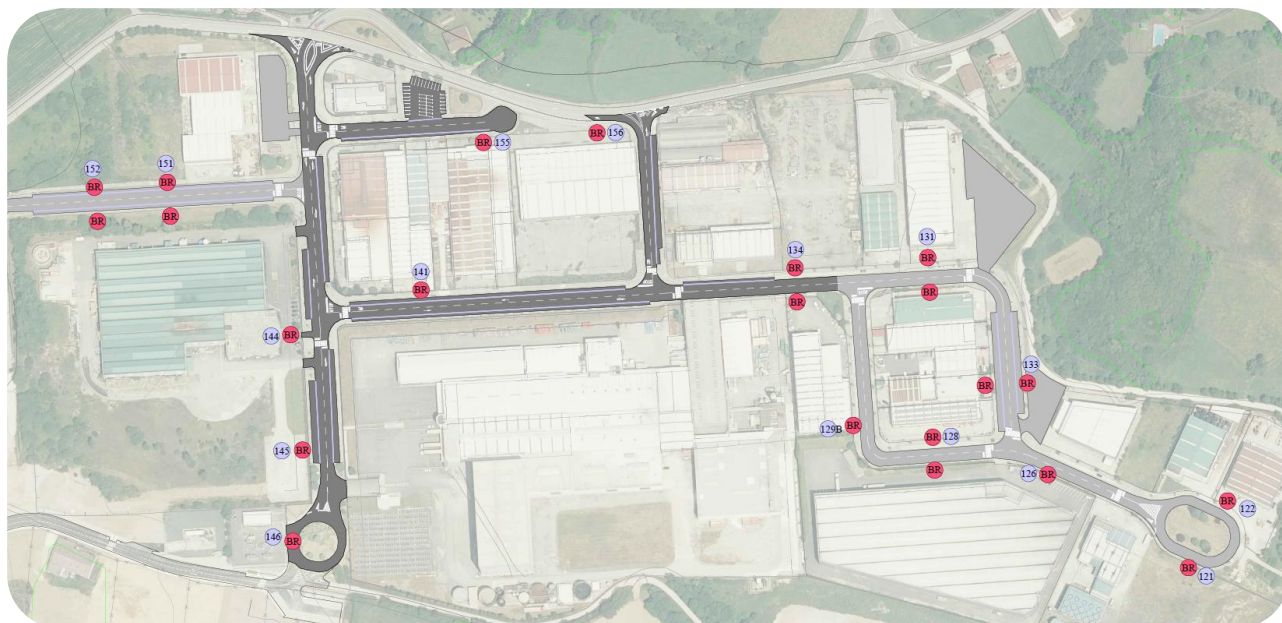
Zonas de renovación de la capa de rodadura de la pavimentación y puntos de renovación de las BR tipo "lanza"
